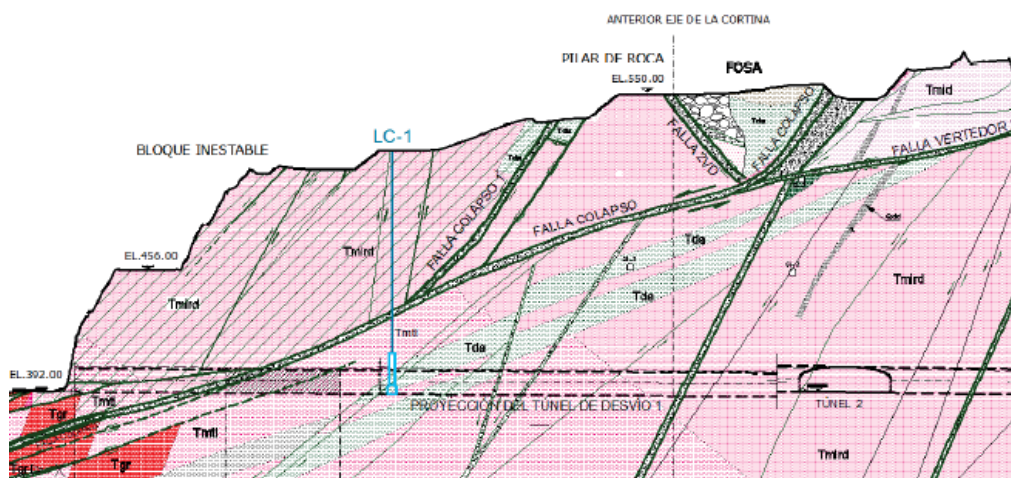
11 Sección esquemática que ilustra el bloque inestable, el pilar de roca entre las falla 2VD Colapso1 así como la fosa entre las fallas 2VD y Colapso.
